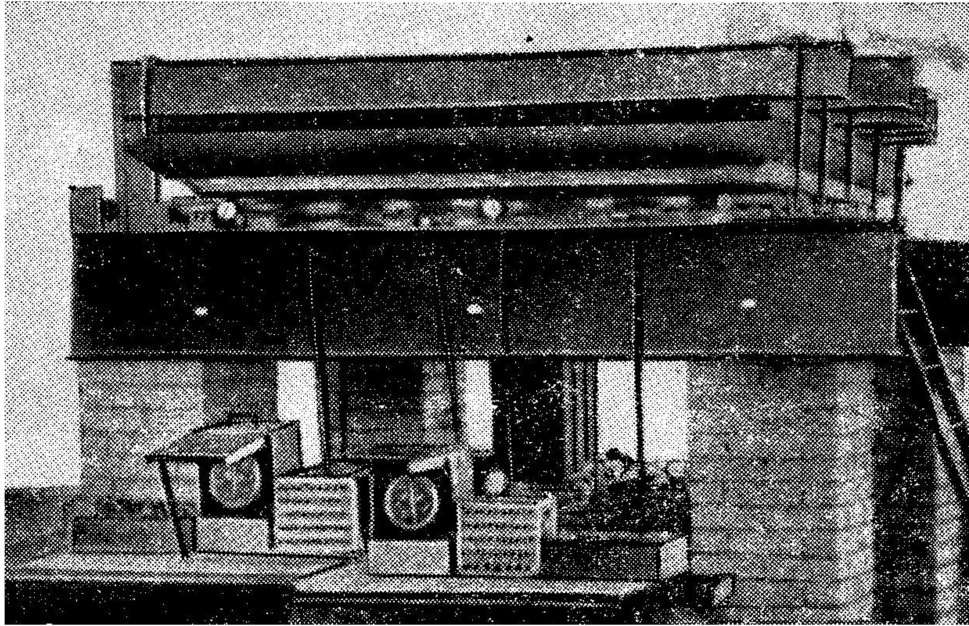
Общий вид установки для испытания плит сжатым воздухом
